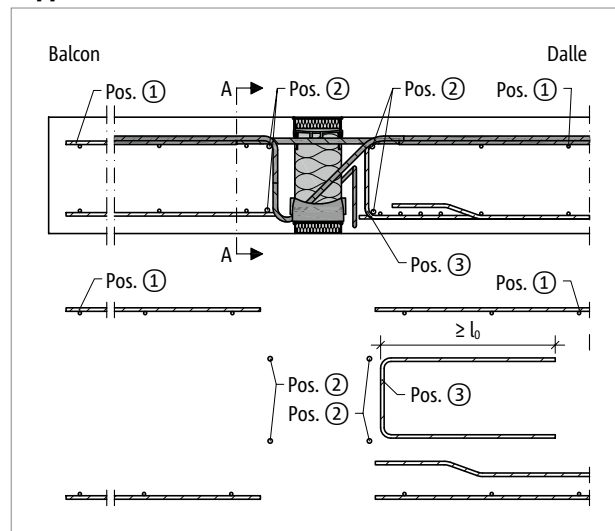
Schöck Isokorb® T Type K-E, K-T : Renforcement sur site ; plancher avec poutres de rive
